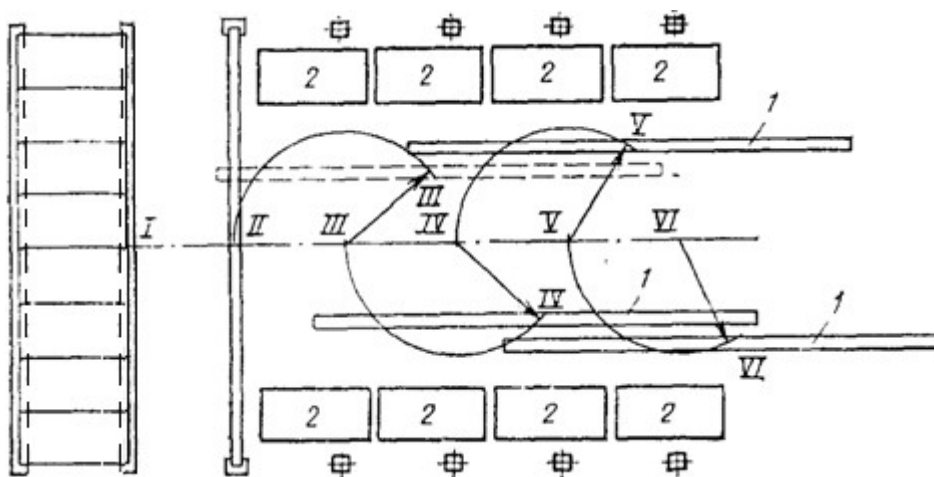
Розкладка ферм у прольоті: 1 – розкладені ферми; 2 – штабелі з плитами покриття; I...VI – порядкові номери ферм і стоянок крана при монтажі
